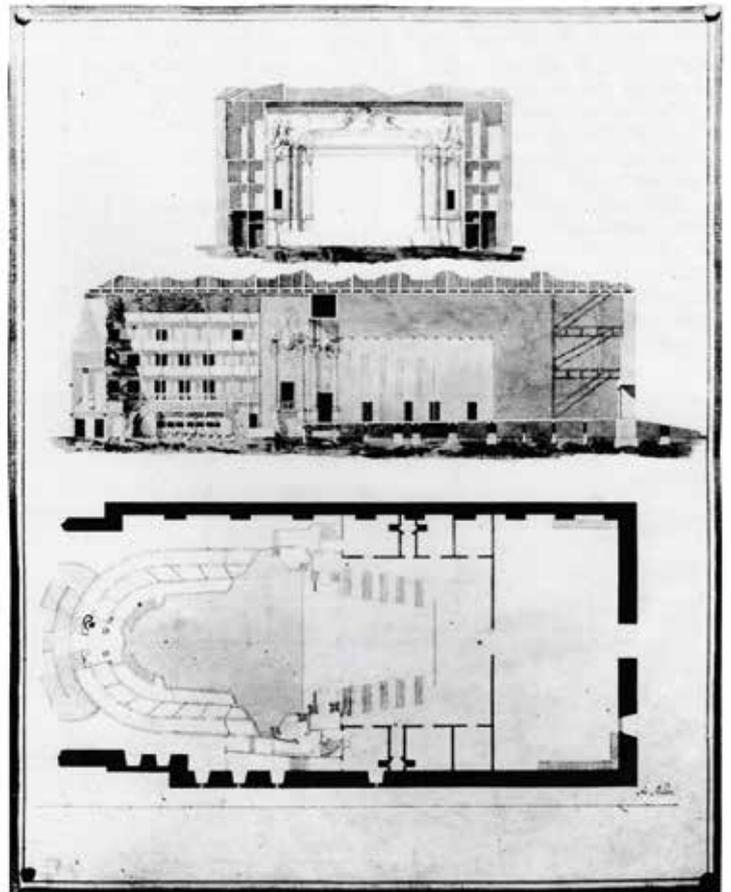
Grundriss, Quer- und Längsschnitt mit bereits reduziertem Bühnenraum, Carl Christian Riedel 1817/18, Nachzeichnung
